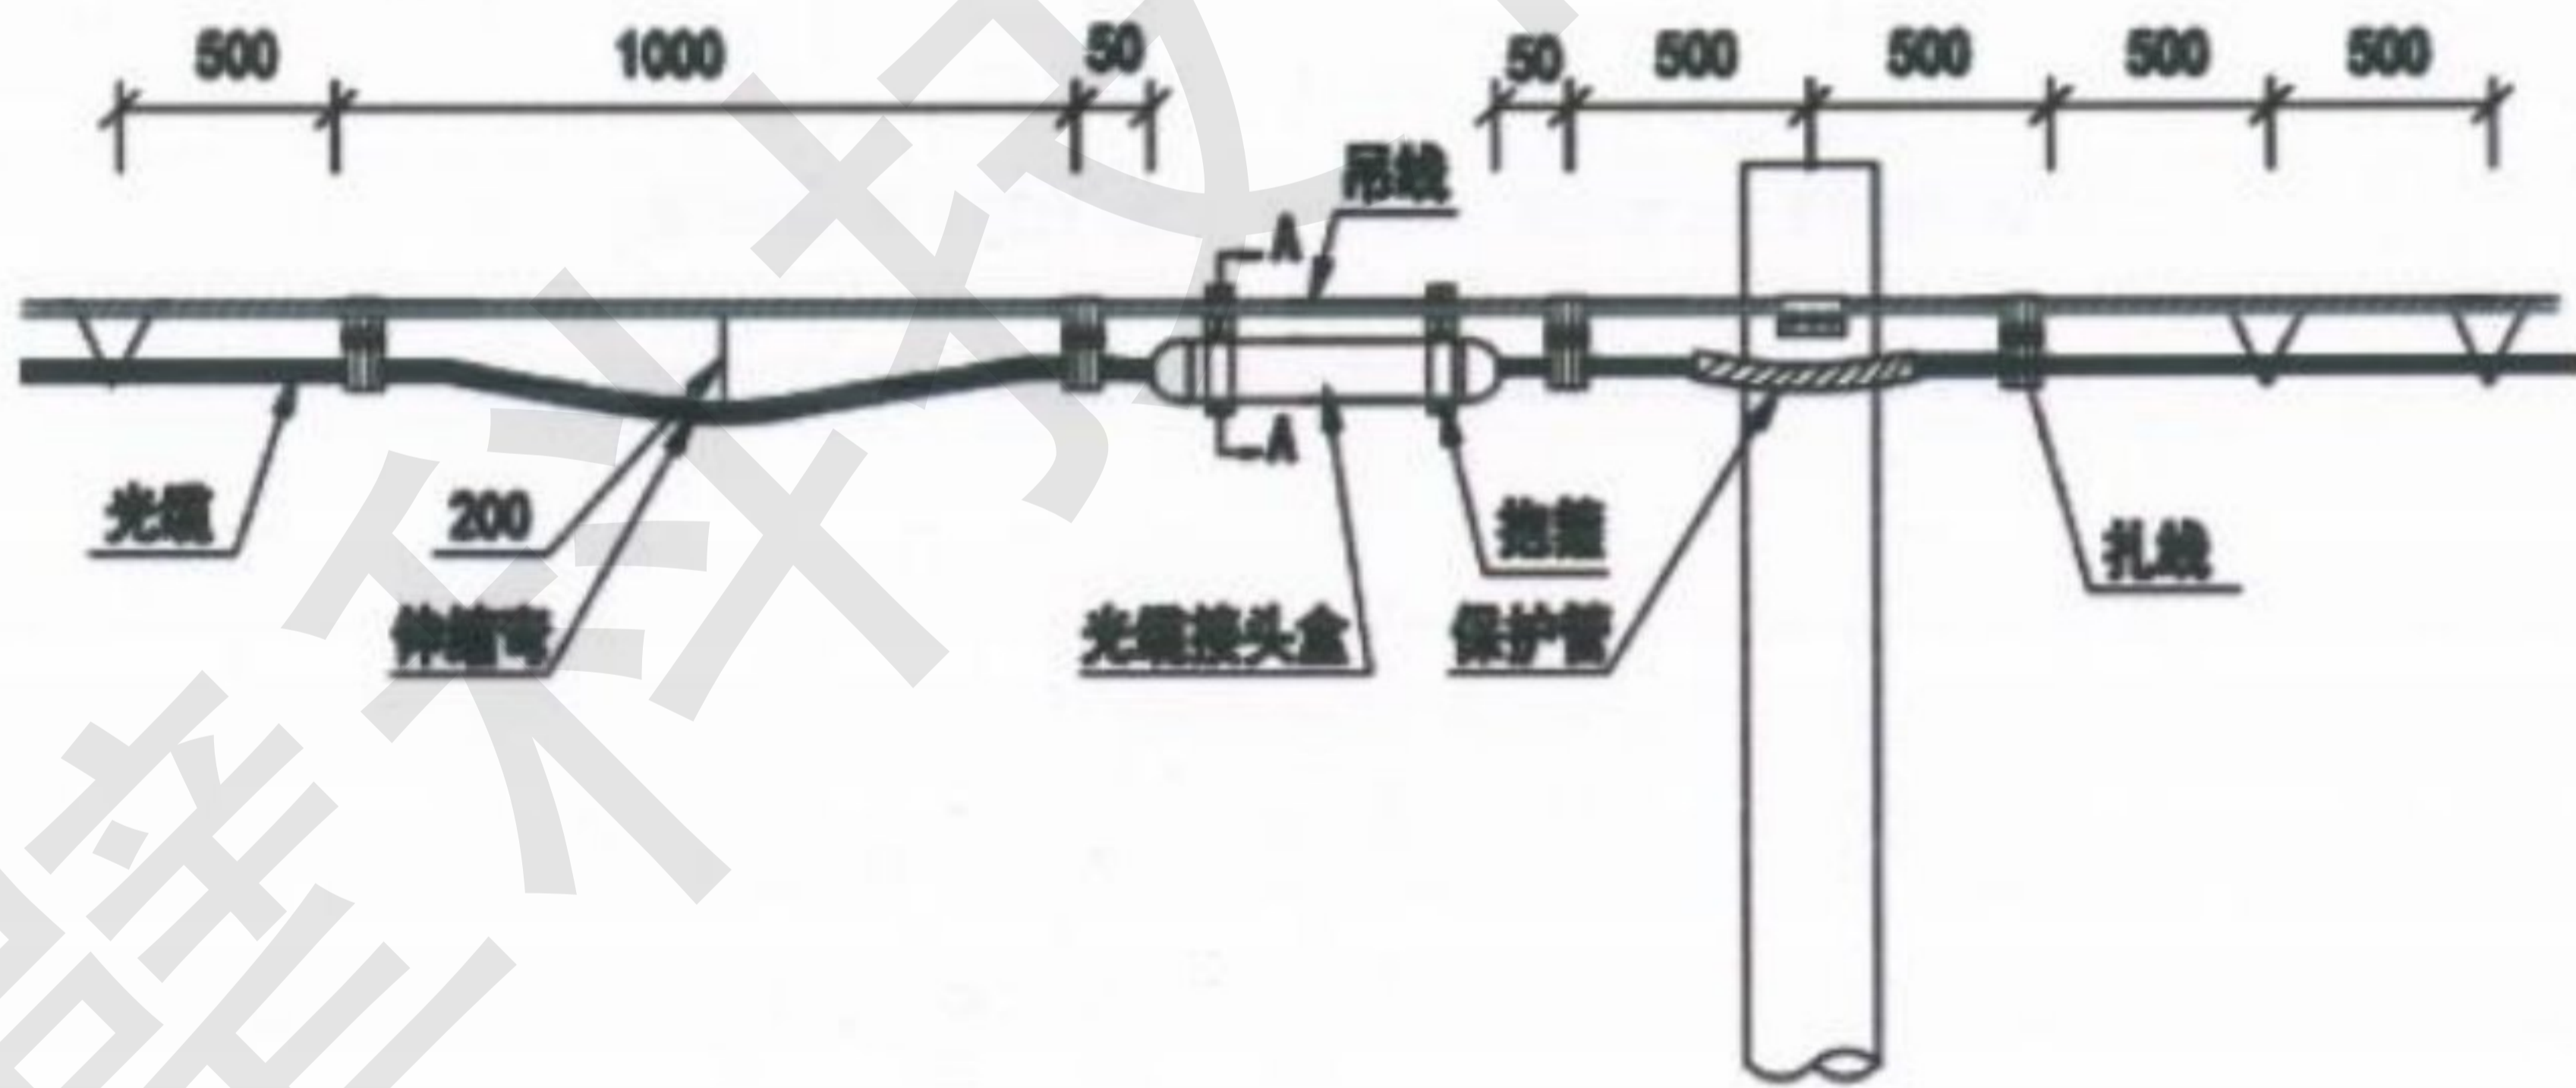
光缆接头盒吊线安装示意图 (单位: mm)
